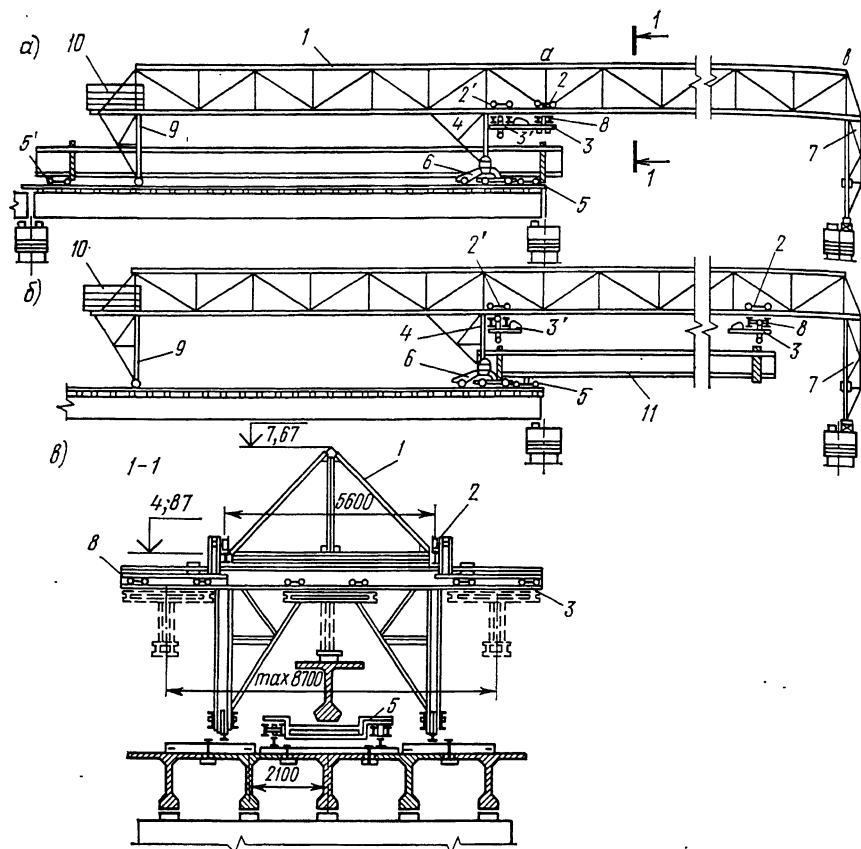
Монтаж балочного пролетного строения консольно-шлюзовым краном
